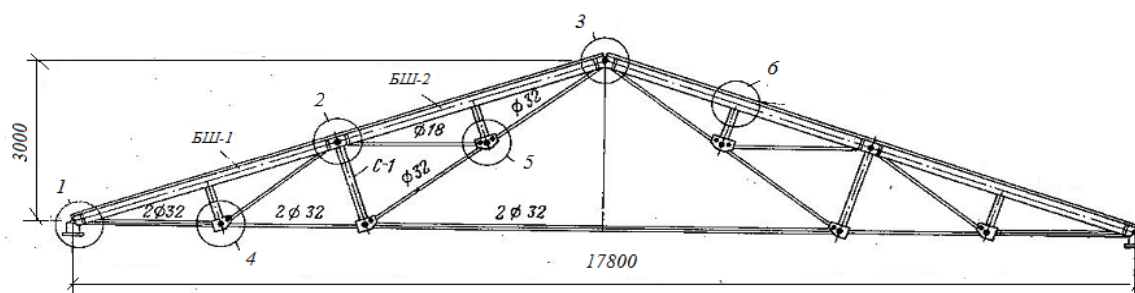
Треугольная металлодеревянная ферма пролетом 17,8 м с брусчатым верхним поясом (тип-3)
